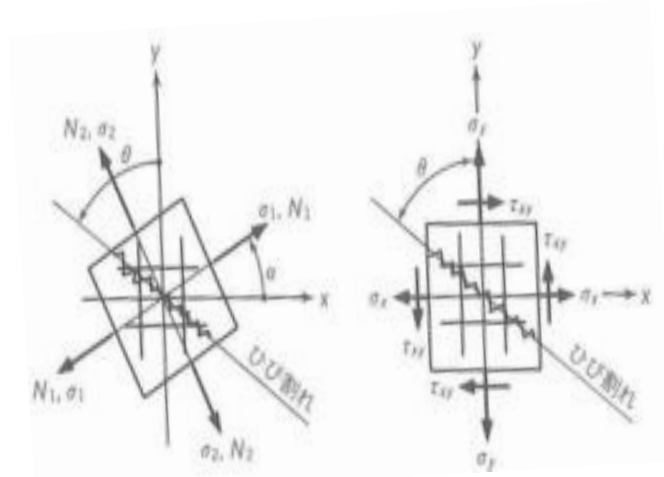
面内力を受ける直交配筋鉄筋コンクリート平板の単位要素
